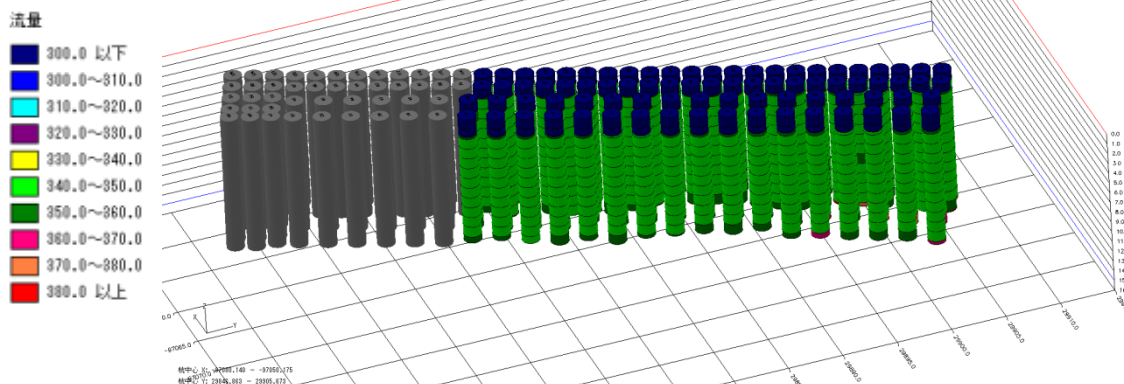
地盤改良工の3D施工記録(着色部：施工済みの箇所)
